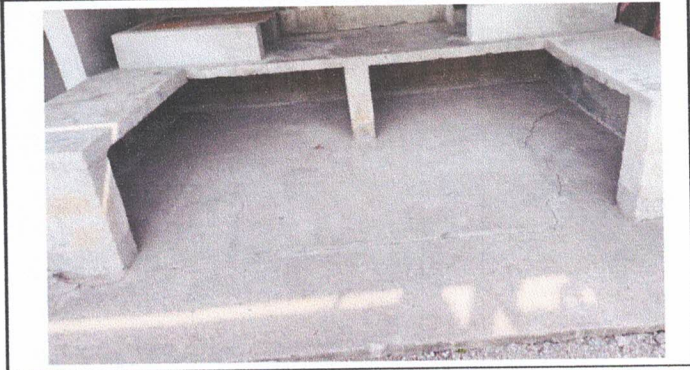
SUSTITUCIÓN O INSTALACIÓN DE PLANCHA DE CONCRETO EN COCINA
